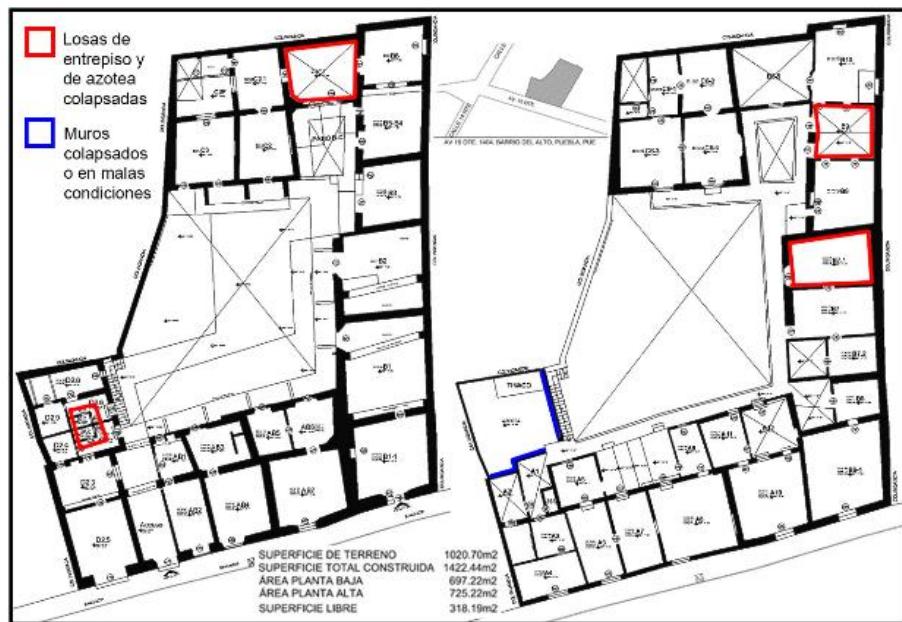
Planimetría generada a partir del levantamiento arquitectónico
